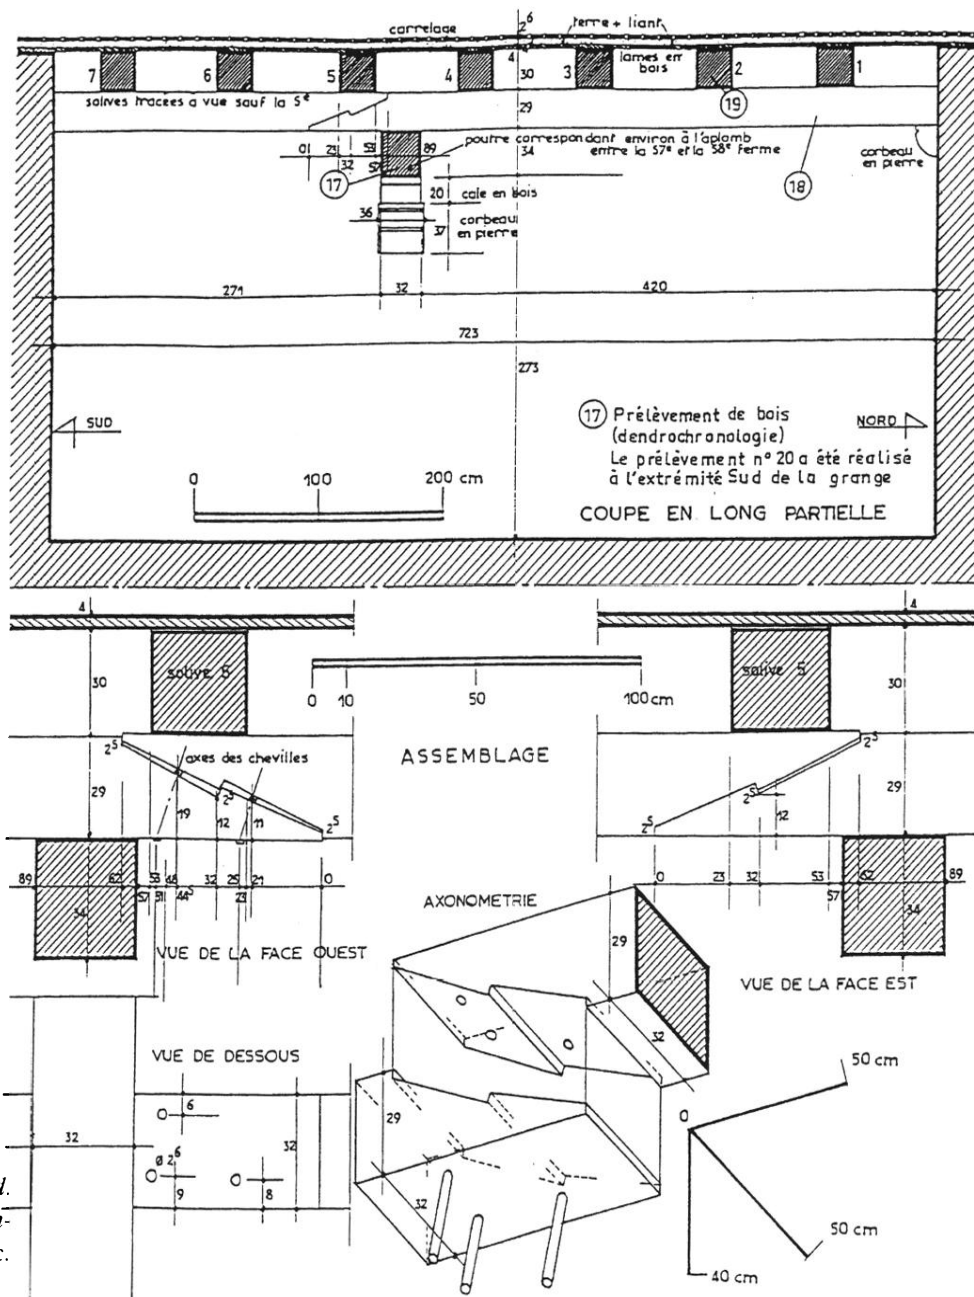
Rez-de-chaussée au sud. Local 3- Cours de poutres- Assemblage. (Dessin H. Rezza Doc. C.R.M.H.)
